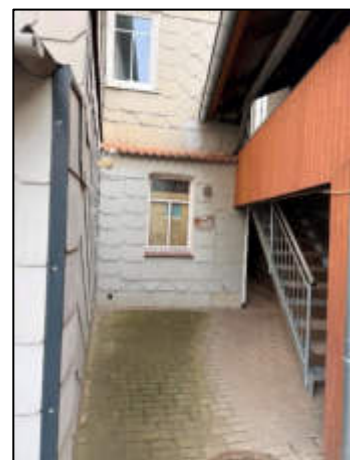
Hofseitiger Hauseingangsbereich mit Zugang zum Laubengang auf der Gebäuderückseite
